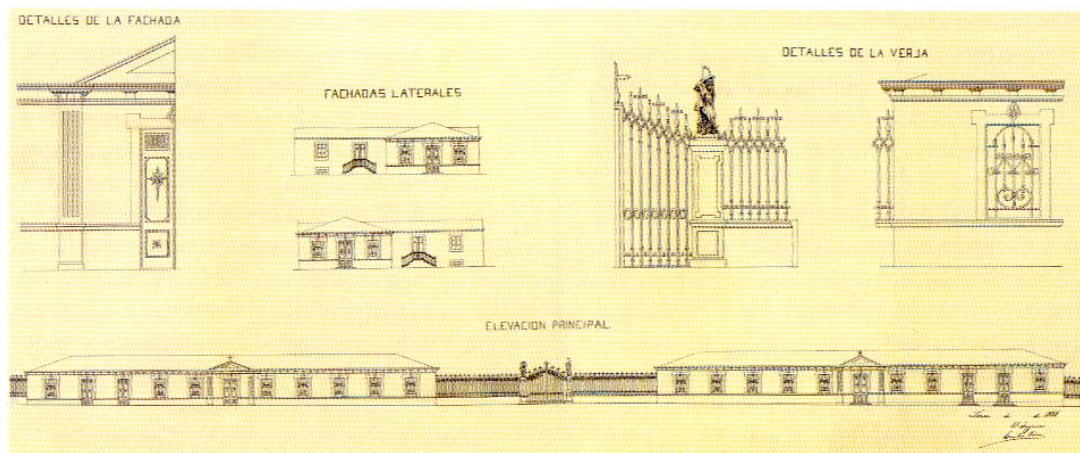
Detalles de la fachada, fachadas laterales, detalles de la verja y alzado de la fachada principal. 1888
